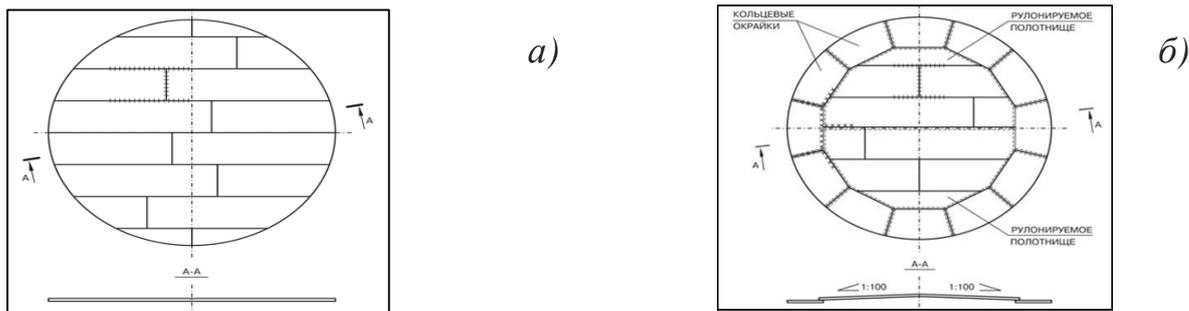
Резервуар вертикальный стальной с разными днищами:
